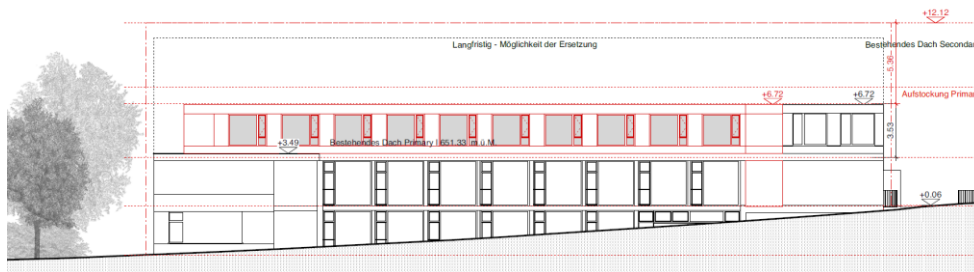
Primary Building, Ansicht Strubenacher, Käferstein & Meister, 21.04.2022
